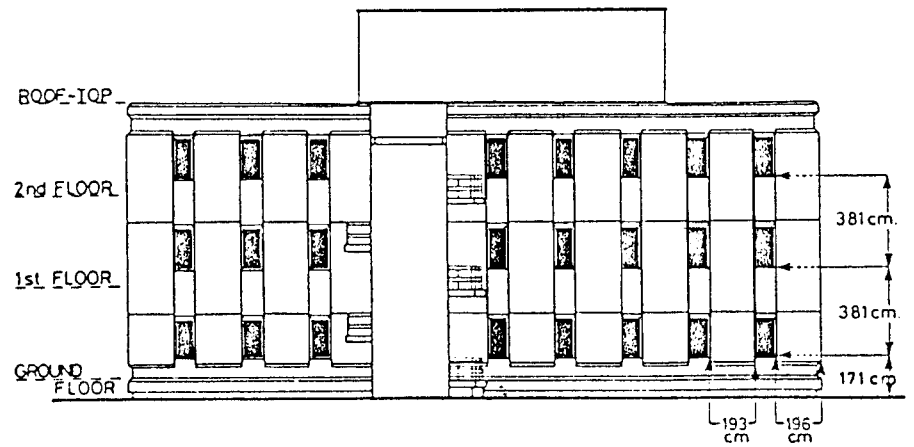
AVON-Bank, Ostansicht (nördliches Ende) und Fassadendetail
